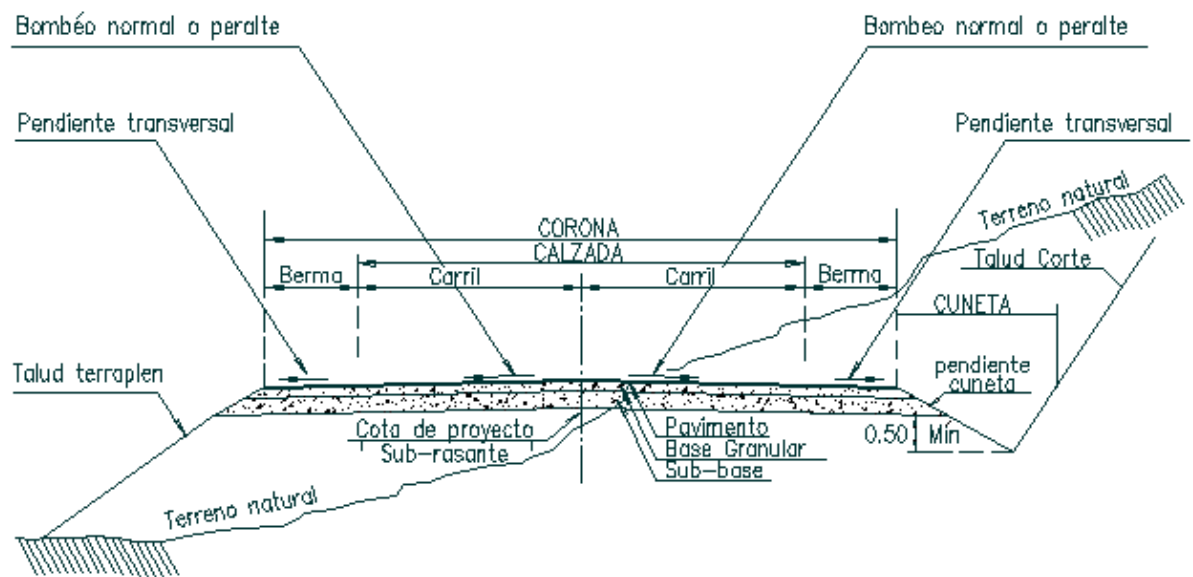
sección transversal típica de un pavimento flexible (sección en balcón).
